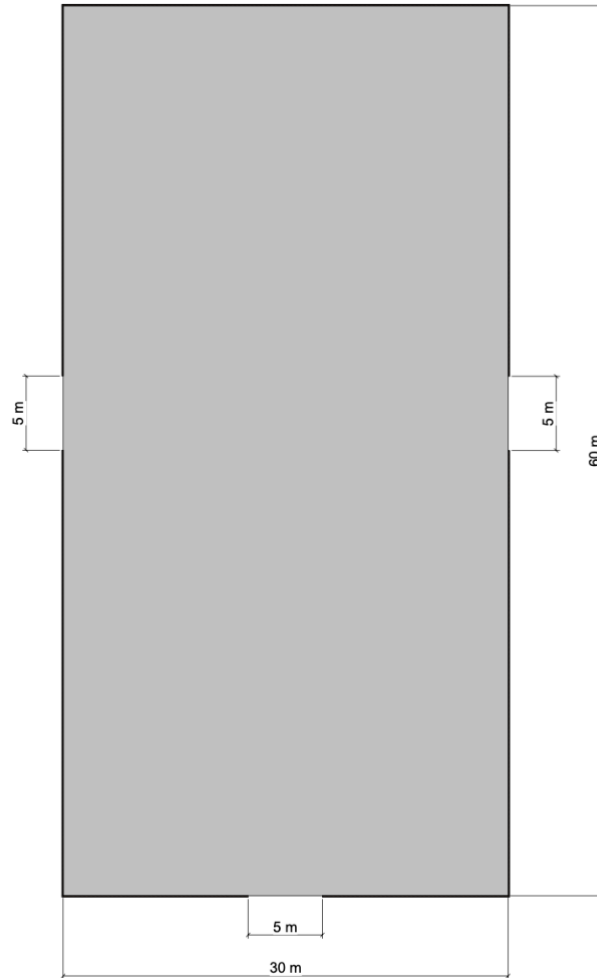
Vista superior de la planta baja de la solución volumétrica B. Fuente: Elaboración propia.
